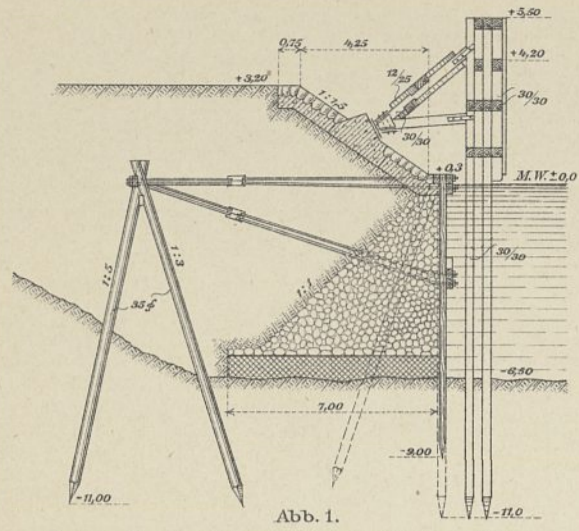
Runde Deckwerkstrecke am westlichen Fährbett. (Schnitt A-B in Abb. 9). 1: 250.
